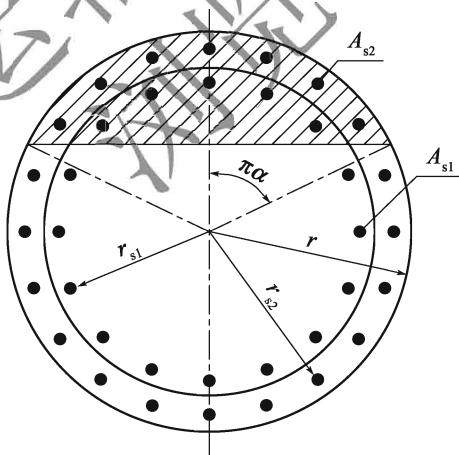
钢筋混凝土圆形截面增大截面(围套法)加固示意
